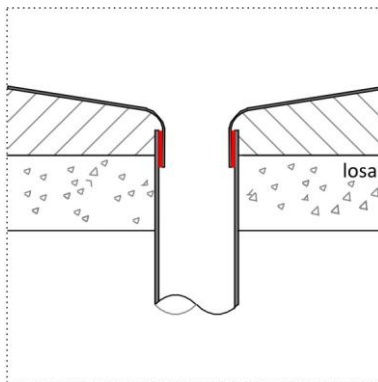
g _ La impermeabilización ingresa y se adhiere a la tubería.
